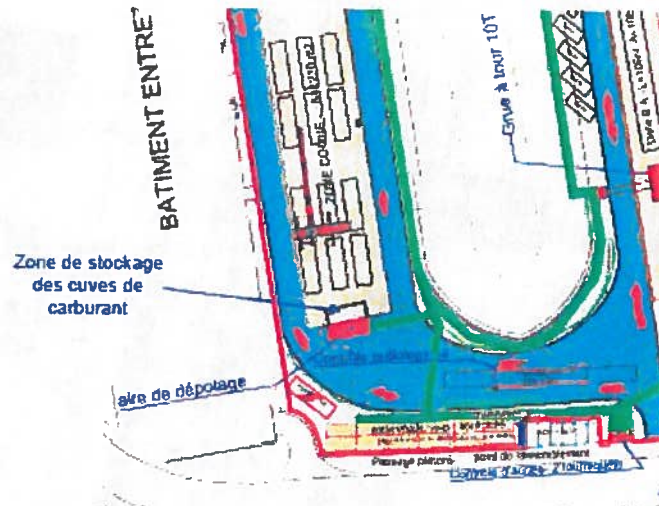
Plan du chantier de déconstruction des ex-SNLE M4
